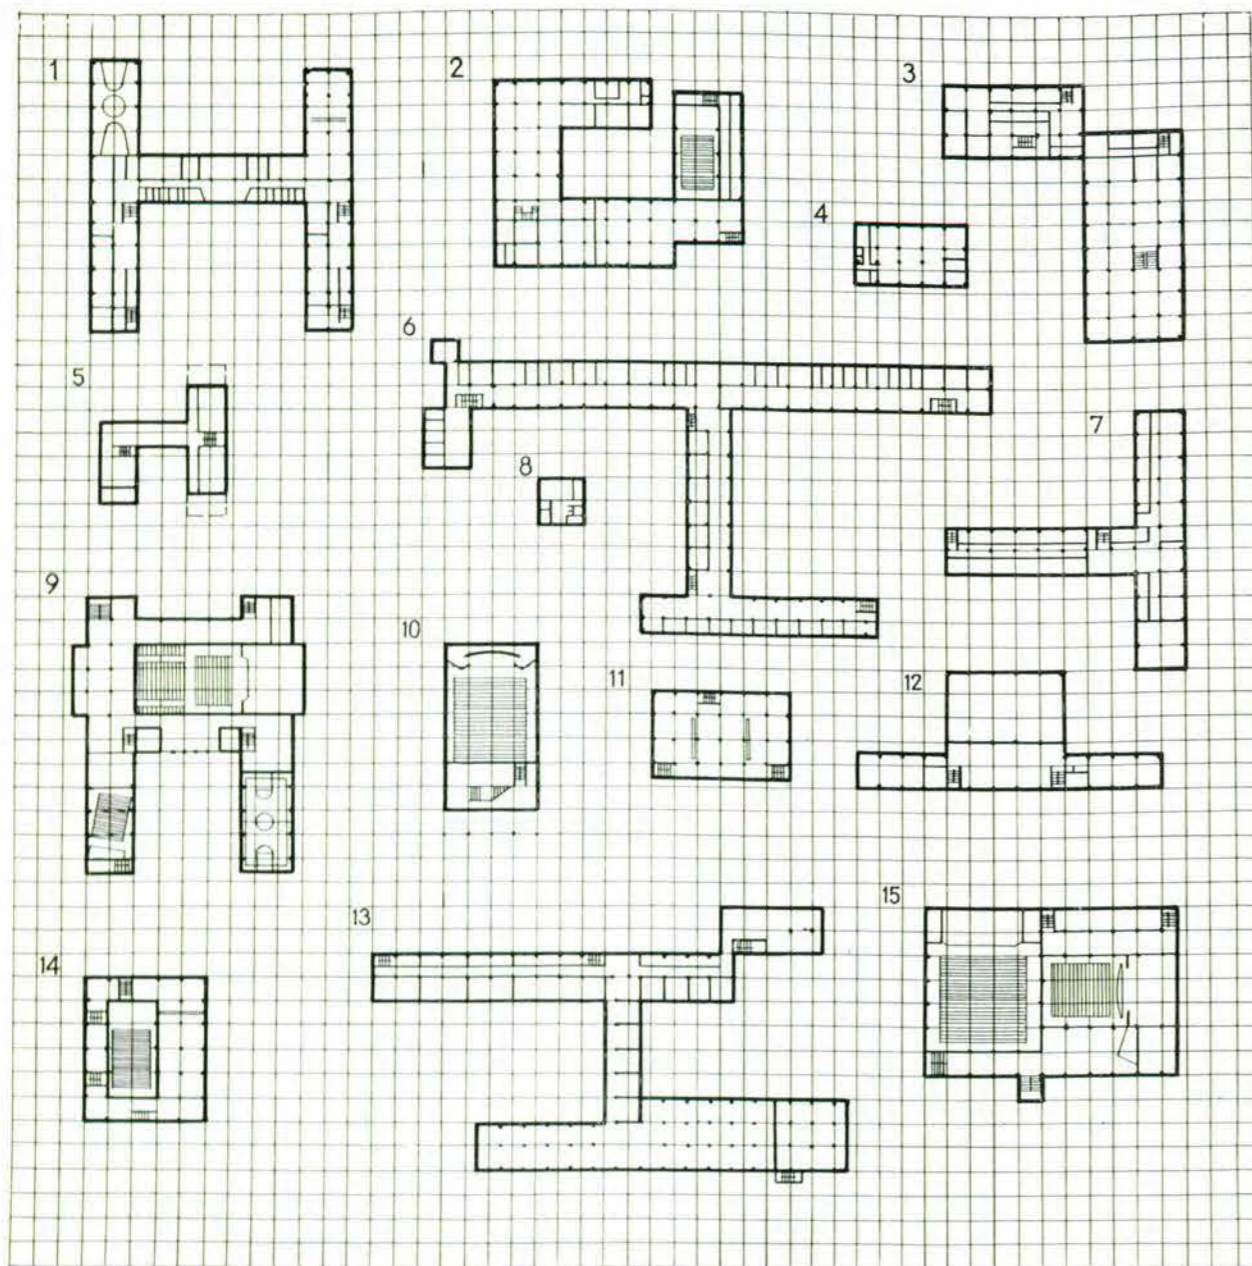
Grundrißschemata von Gebäuden unterschiedlicher Zweckbestimmung unter Verwendung einer einheitlichen Skelett-Großplattenkonstruktion
